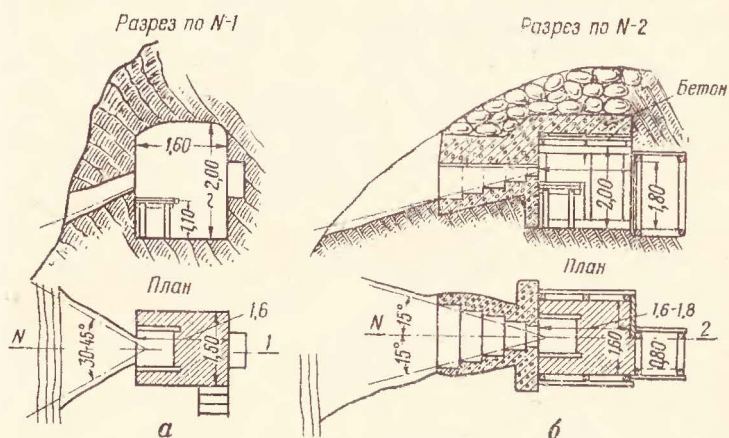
Закрытое пулеметное сооружение с железобетонным оголовком
